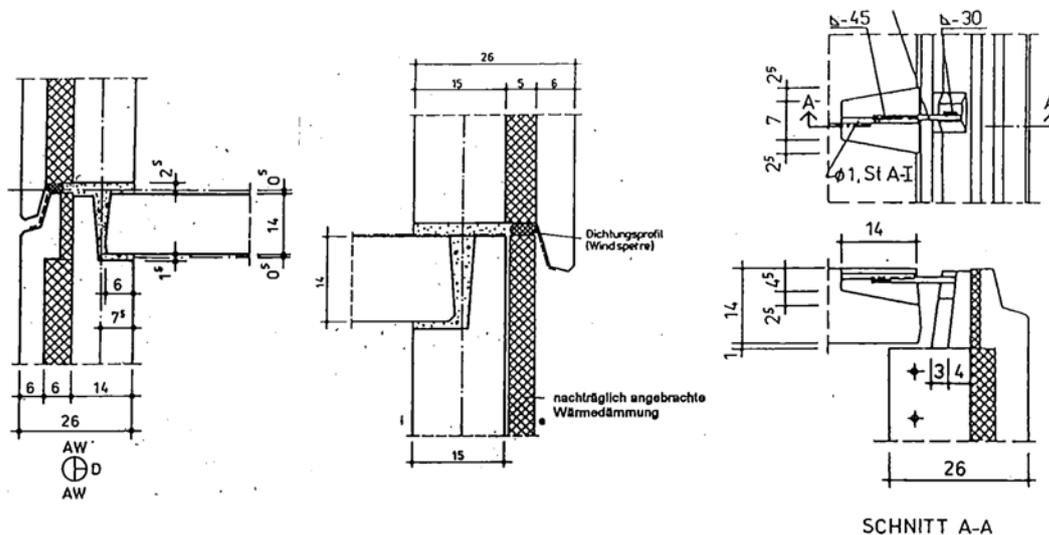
Detail Anschluss Außenwand/Trenndecke PH01-03
